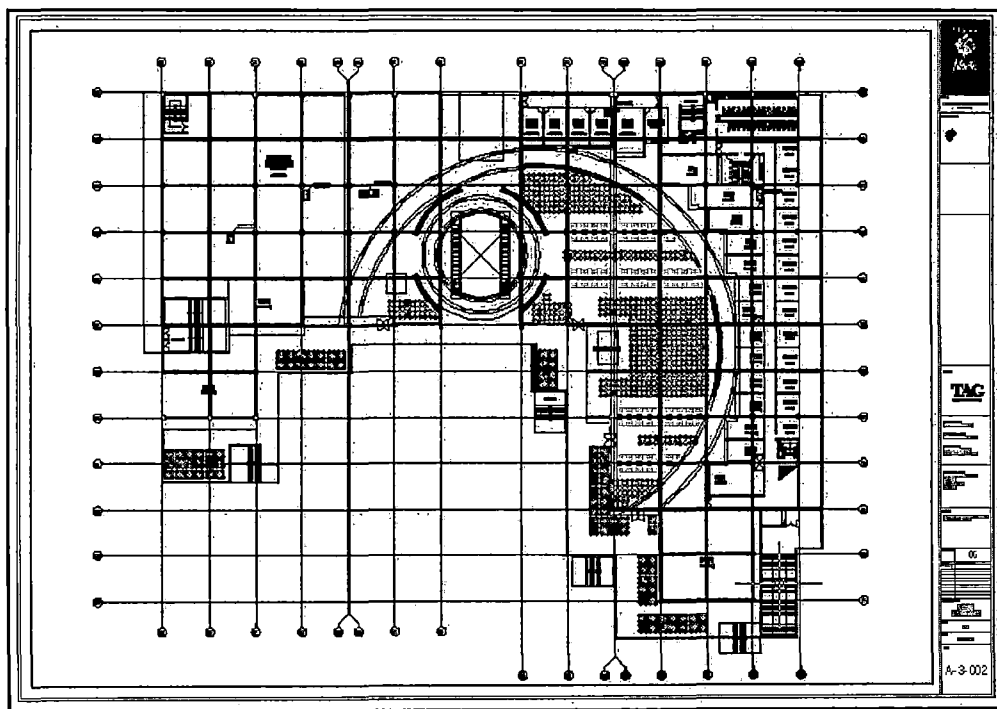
PLANTA SEGUNDO NIVEL DEL SECTOR 03.
